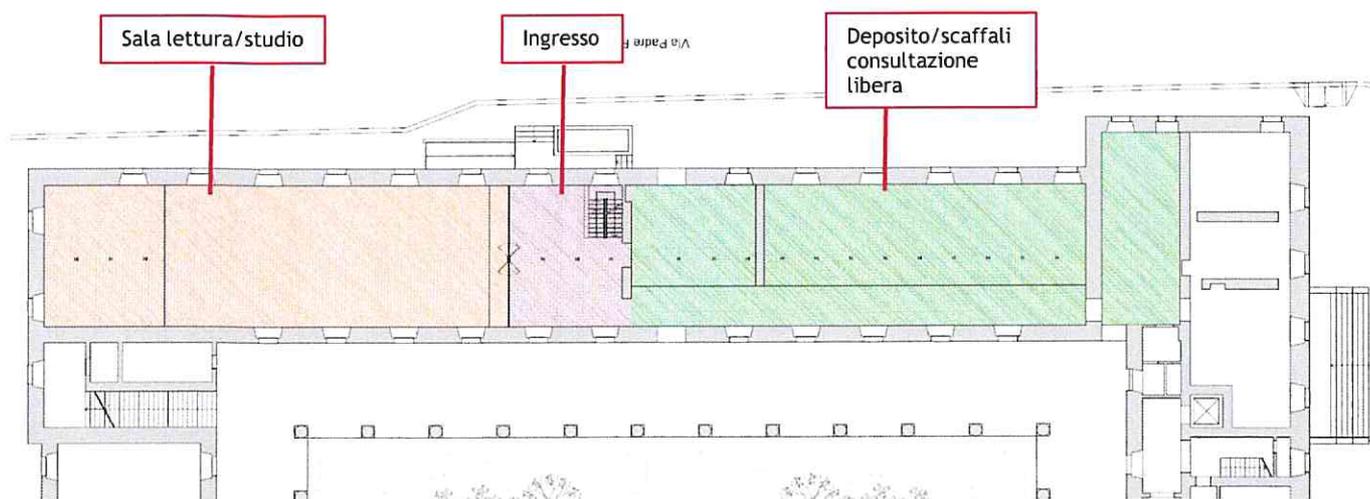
\_Planimetria Biblioteca Civica dello stato di fatto (piano terra)
